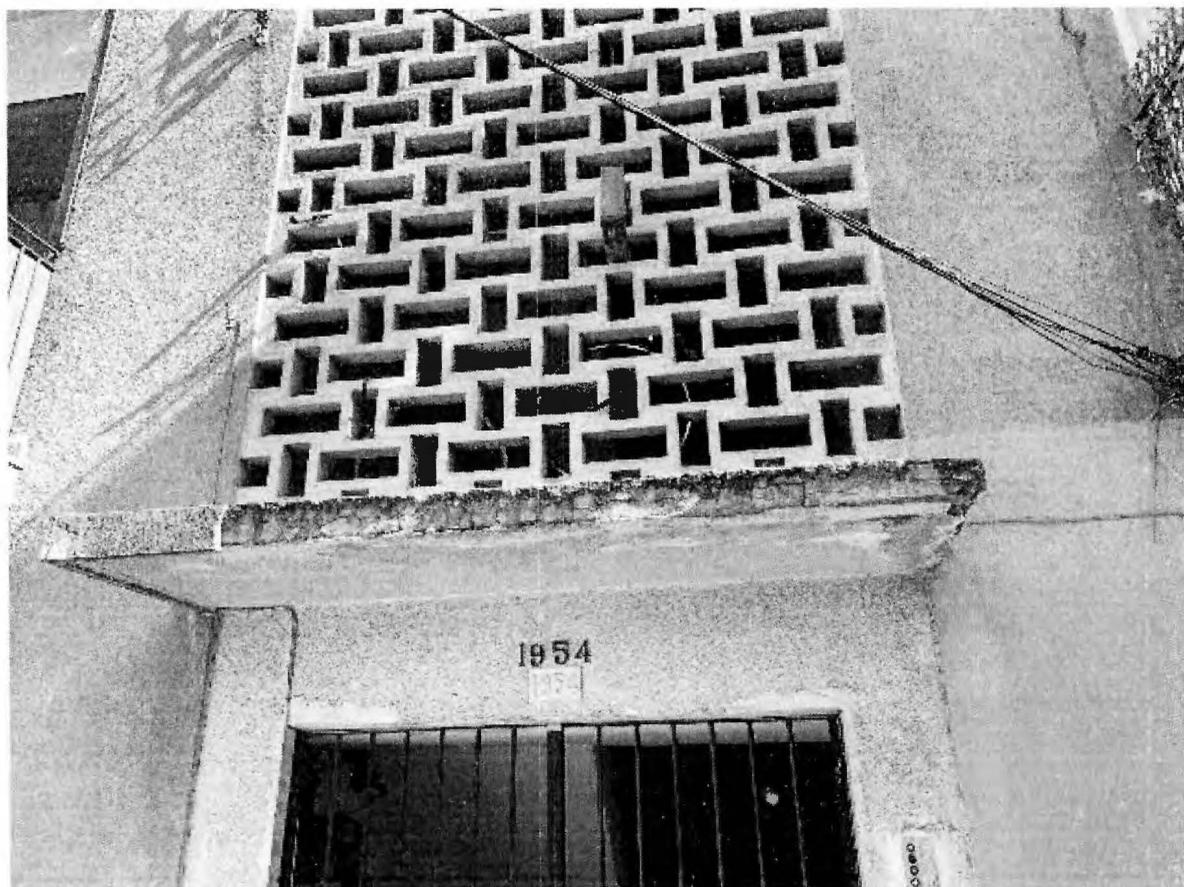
Daño por fisuramiento en marquesina de acceso principal en fachada sur.
